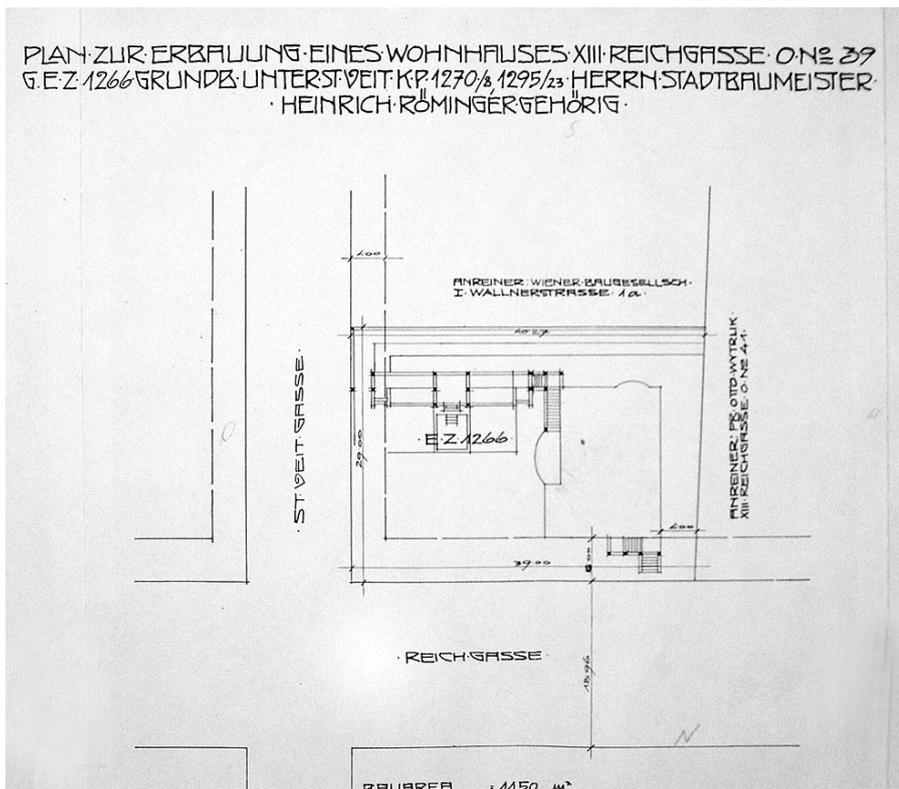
Haus Röminger. Situationsplan. 1913. Einreichplan.
